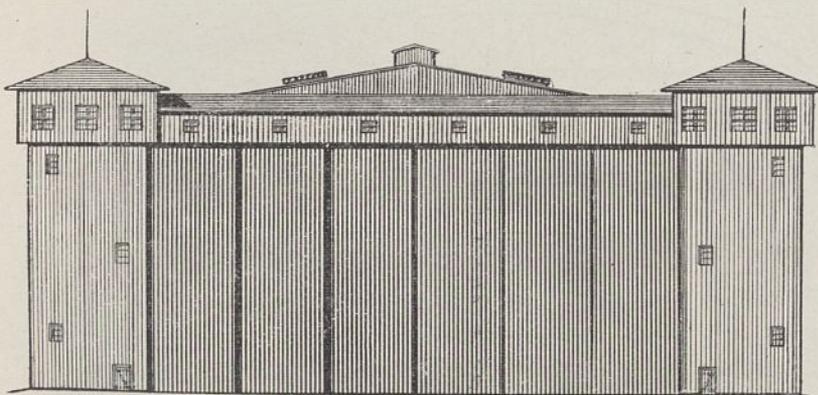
Zweischiffige Bauhalle in Holz mit Betonpfeilern.
